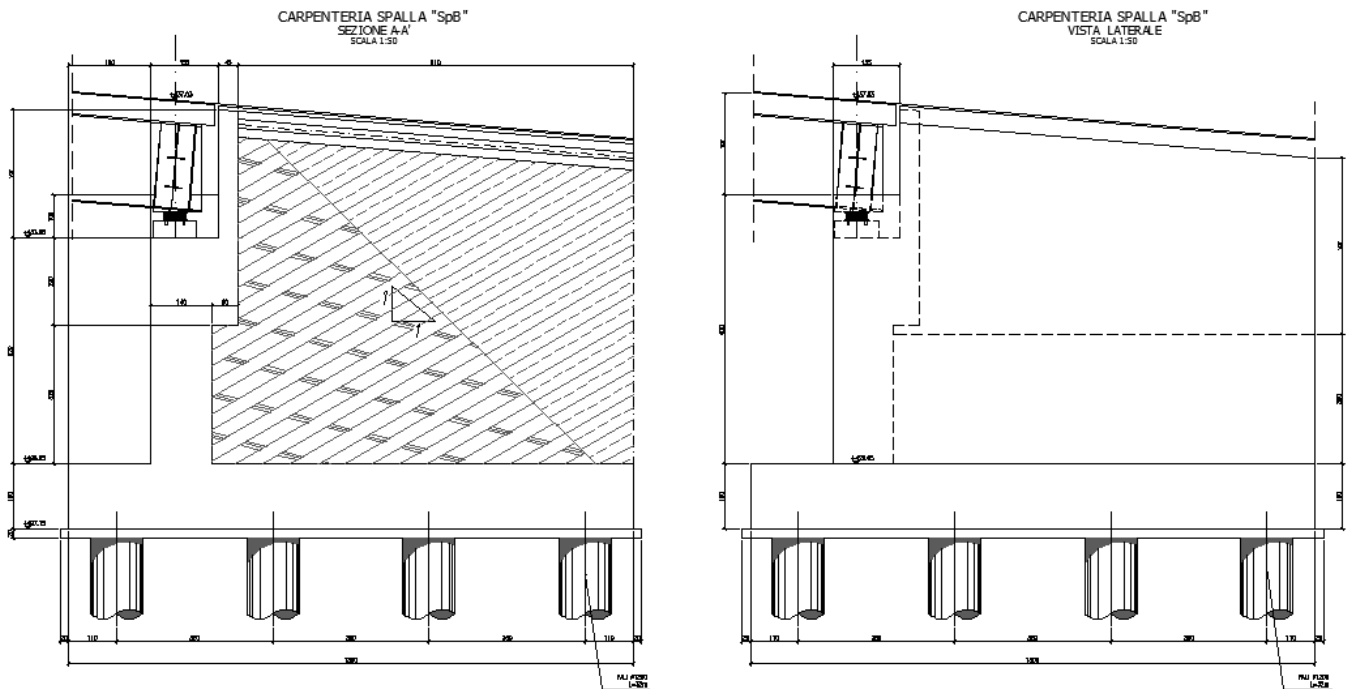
Sezione e vista longitudinale spalla B.
